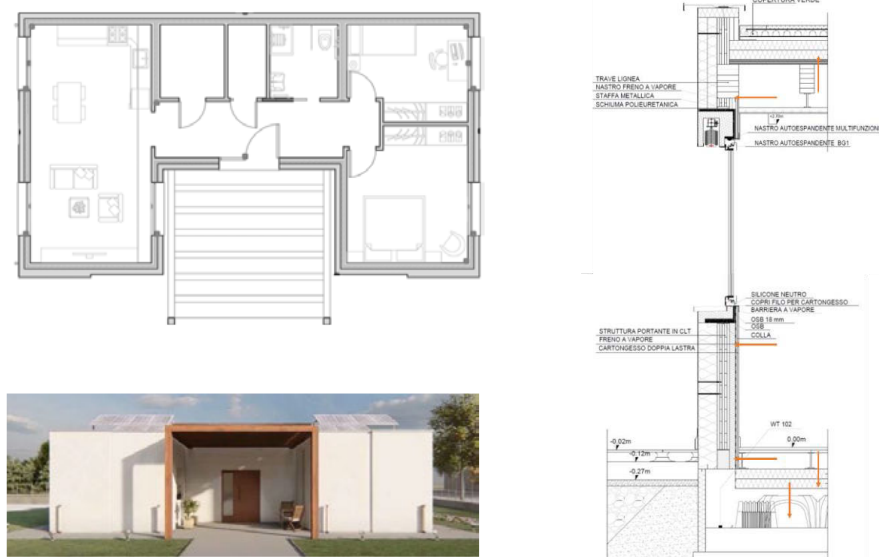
(a sinistra) Pianta e render del prospetto principale;
